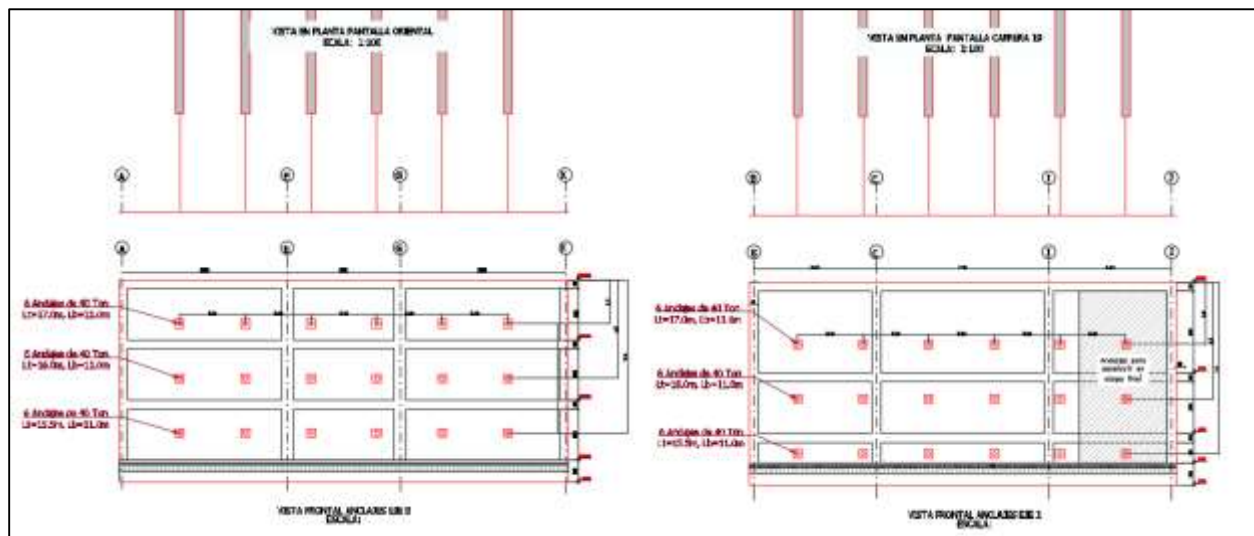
Vista en alzada y planta de Pantallas Oriental y Occidental - Proyecto San Agustín
